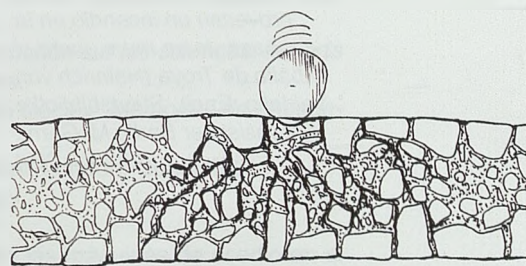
Impacto de un bolaño sobre un muro de fábrica de piedra (vista en planta) y daños internos producidos. El bolaño impacta contra el paramento exterior, provocando la rotura de las piedras, así como la aparición de fisuras interiores que separan el material y rompen su cohesión. Con la colocación de refuerzos internos de madera, se contrarresta el efecto de estos impactos y se ancla el material en caso de aparición de fisuras
